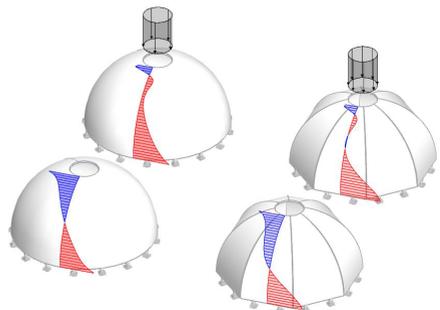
Ringkräfte in Kuppeln ohne/mit Laterne. rot: Zug - blau: Druck (JT).
